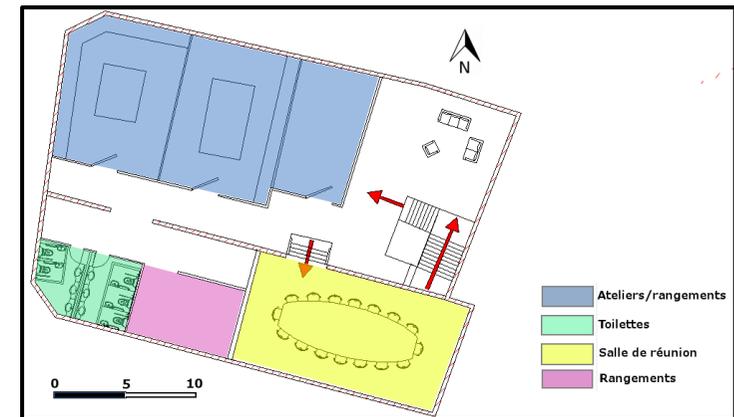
PLAN DE MASSE DU PREMIER ETAGE DE LA MAISON DE LA JEUNESSE
